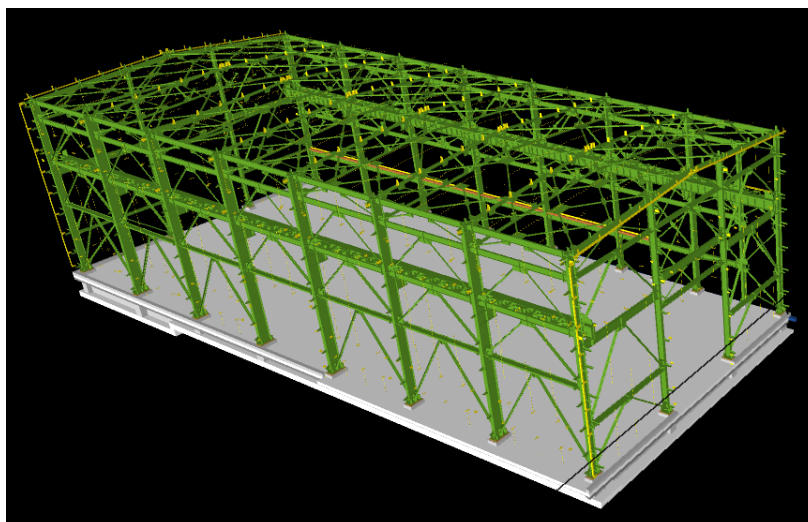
Montaje de armazón del techo y arriostres de fachadas
